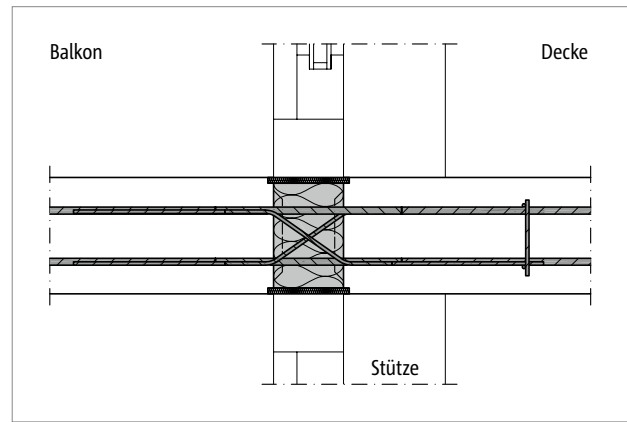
Schöck Isokorb® XT Typ DL: Einbauschnitt; Flachdecke
